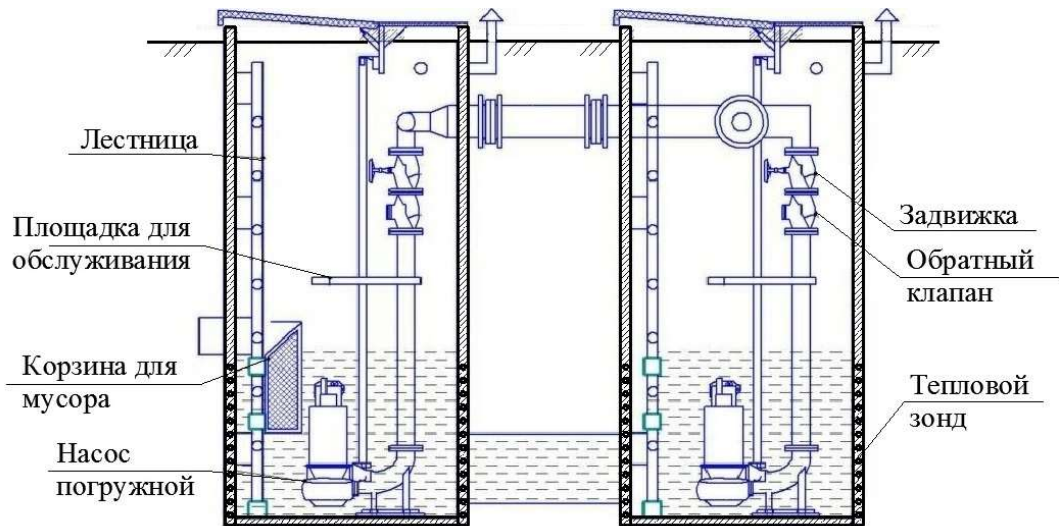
Типовая железобетонная канализационная насосная станция с устройством тепловых зондов.
